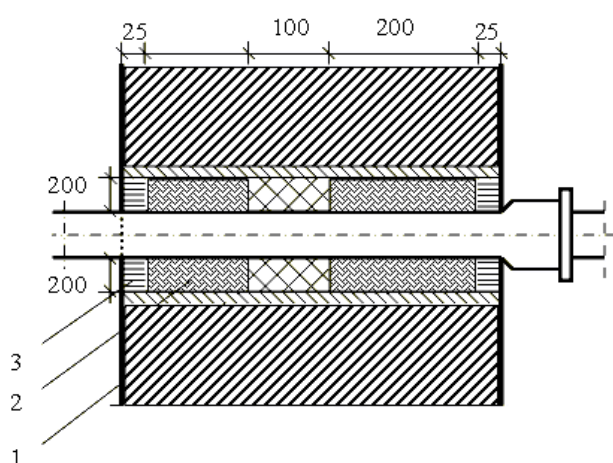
Введення водопроводу крізь стіну підвалу в сухих ґрунтах:
